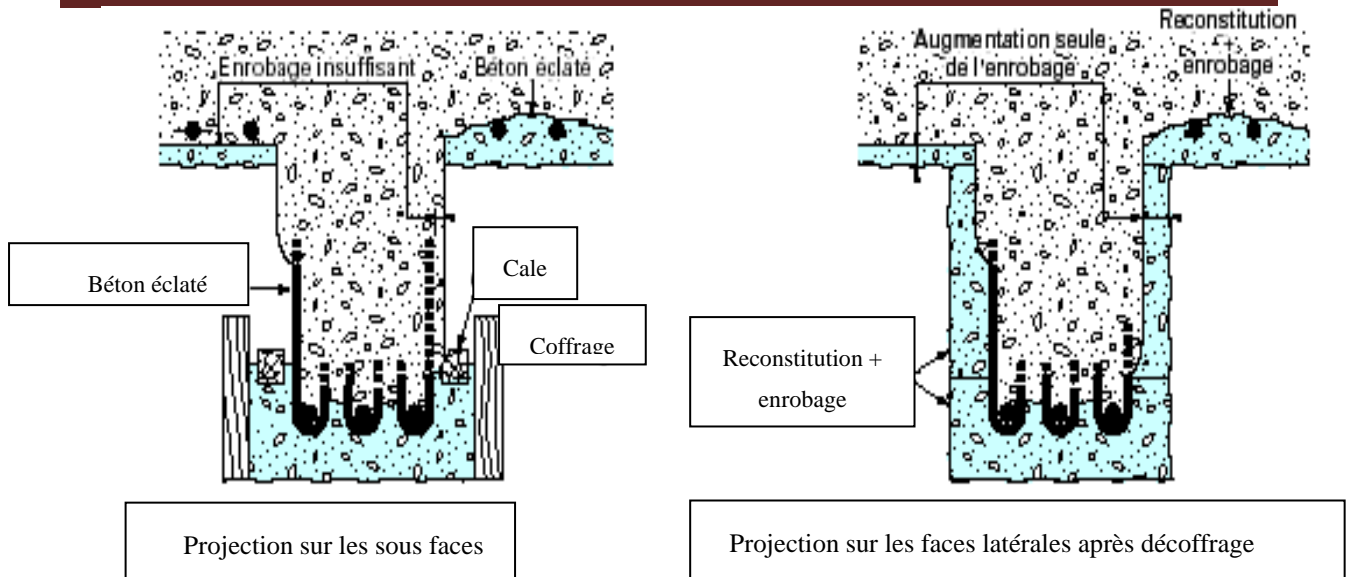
Réparation de poutre par béton projeté sans adjonction d'armatures complémentaires
